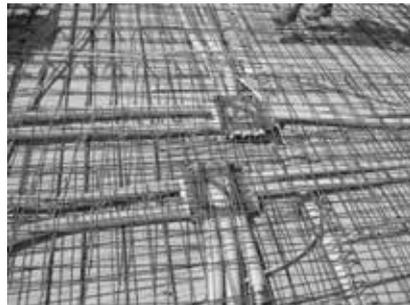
Horizontalverteiler auf Filigrandecke kurz vor dem Betonieren
